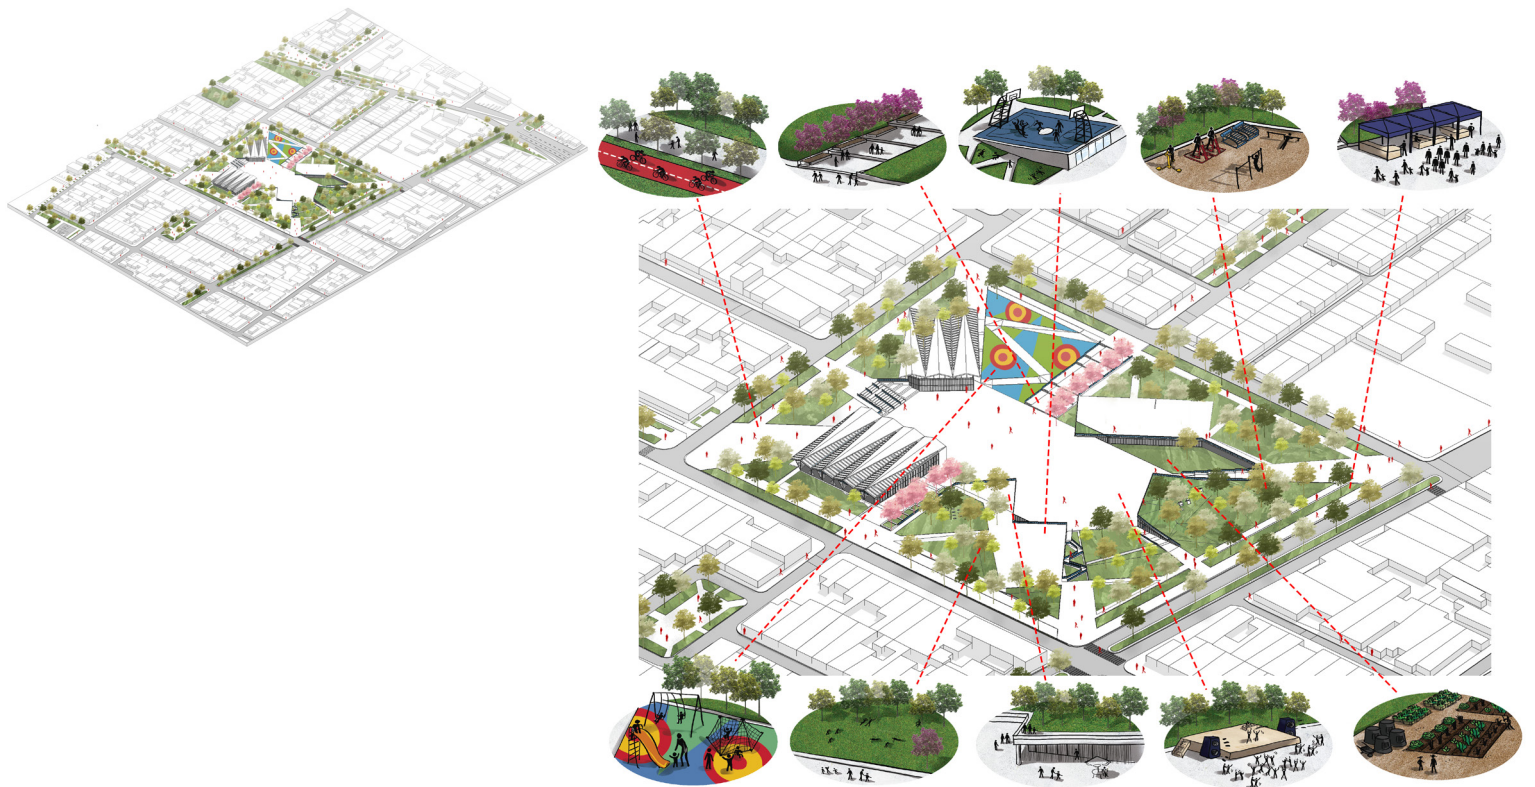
Planta General del proyecto. Fuente: Elaboración Propia - 13/Diciembre/2018
